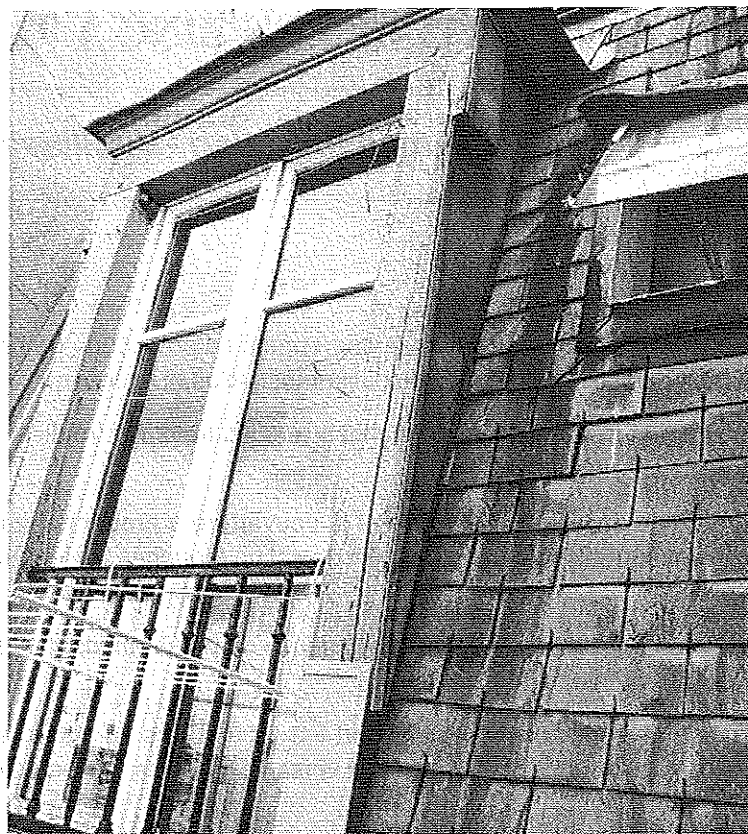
Brisis sur façade cour avec lucarne saillante à terrasson.
